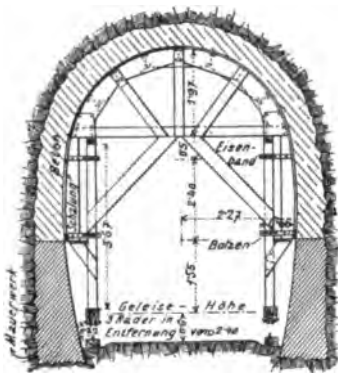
Querschnitt und Einarüstung des Gallitzin-Tunnels.
